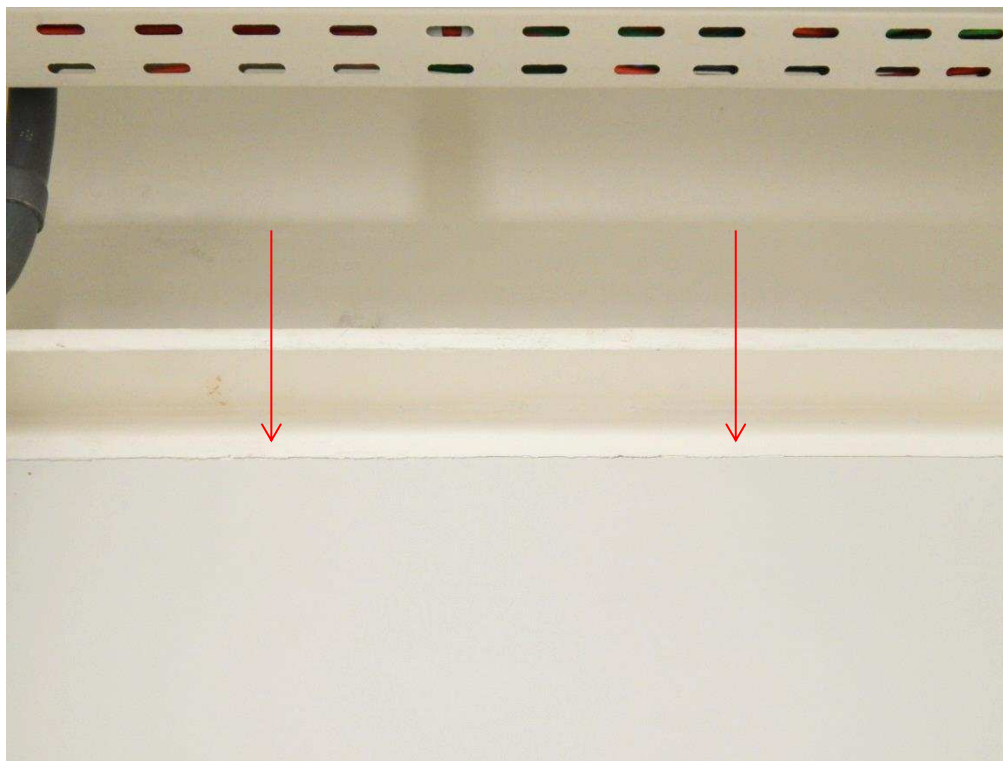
Fissura no local de contato entre a cantoneira de aço e o revestimento final da alvenaria interna.
